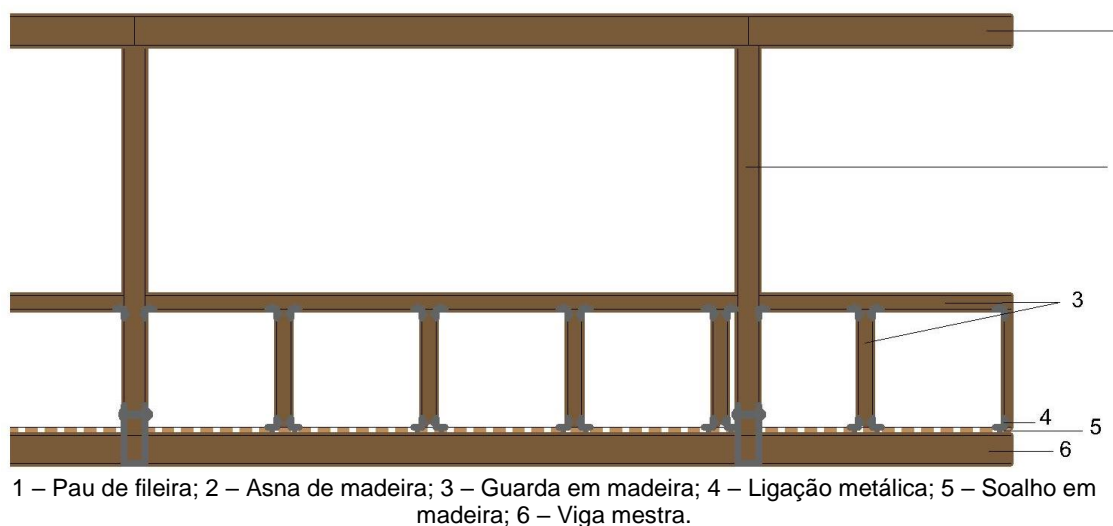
Pormenor longitudinal do passadiço em madeira entre asnas.
